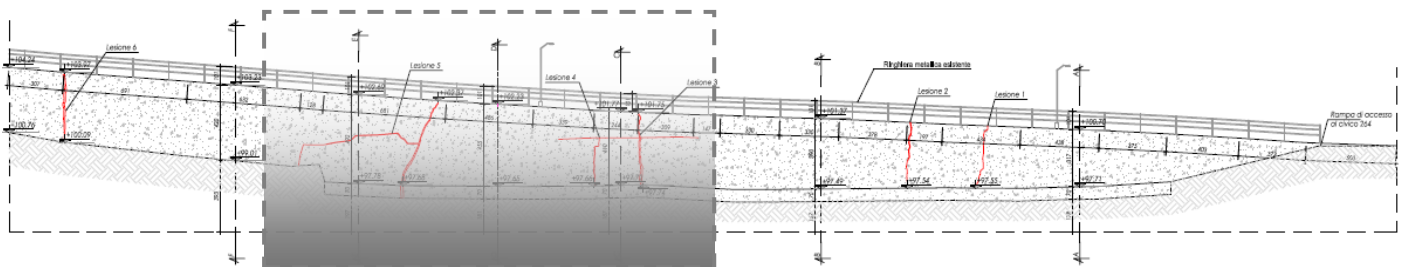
Prospetto con indicazione dello stato fessurativo e dell'area già oggetto di consolidamento
